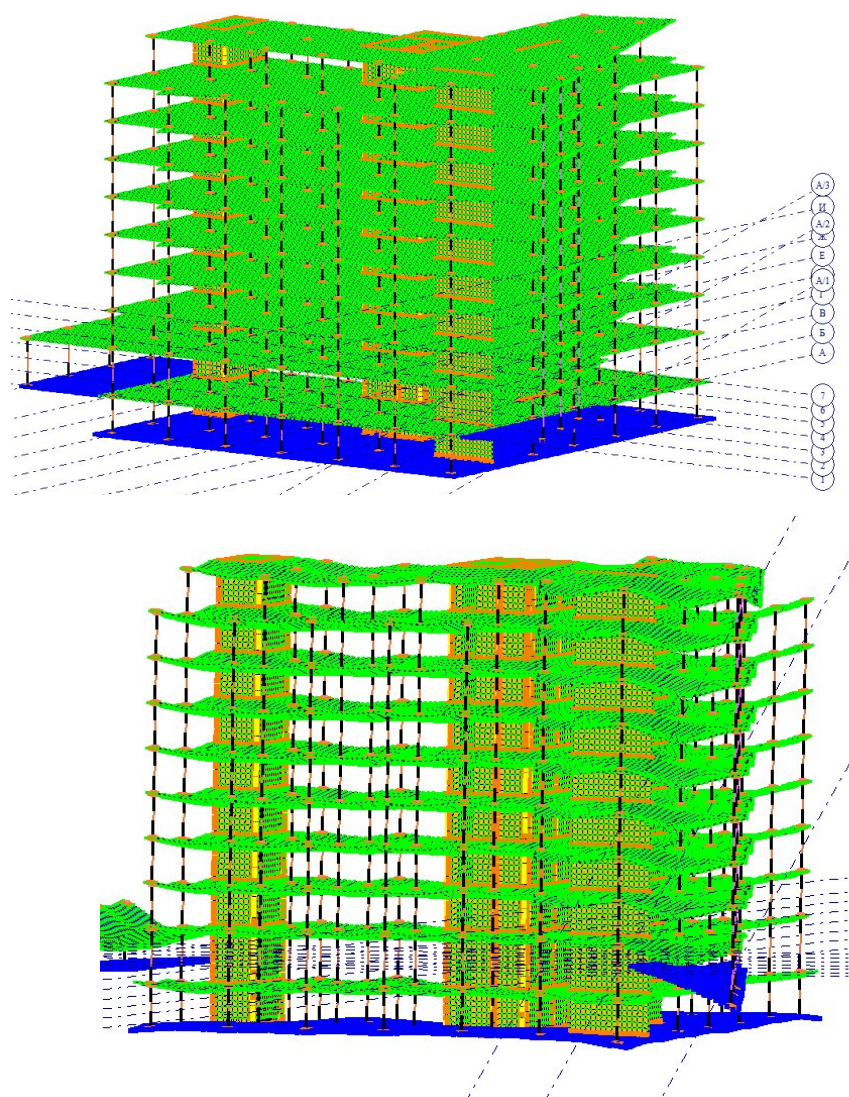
Розрахункова модель і деформована схема будівлі після розрахунку в ПК Ліра САПР
